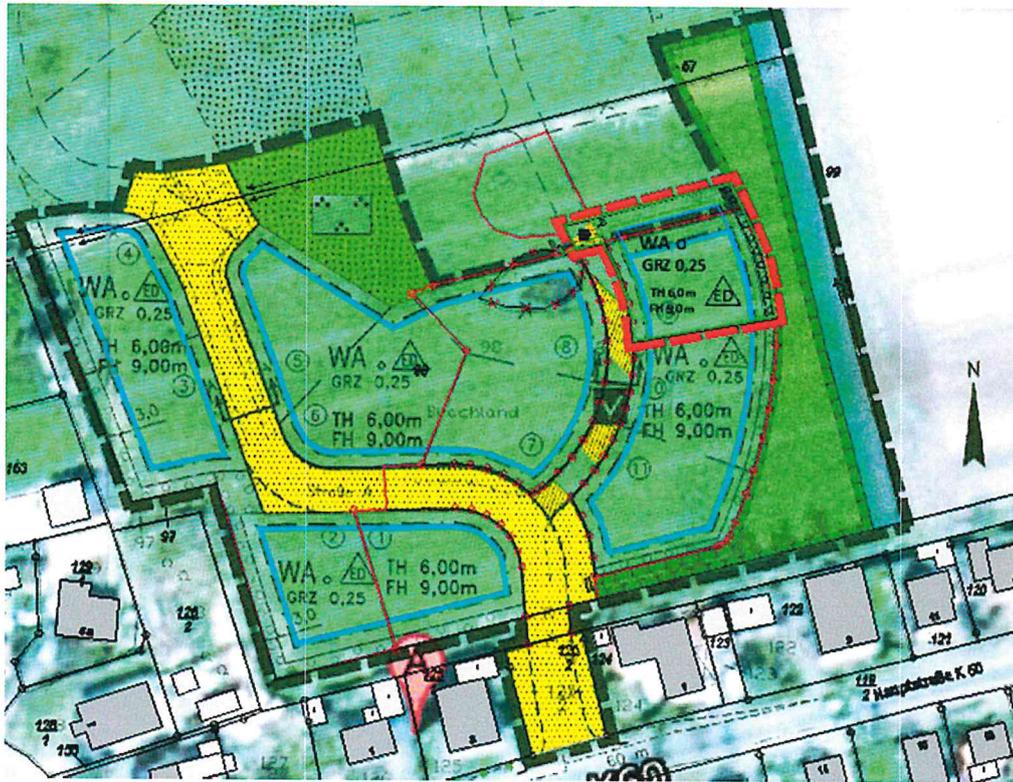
Übersicht des Bebauungsplans Nr. 3 mit Geltungsbereich der 1. Änderung
